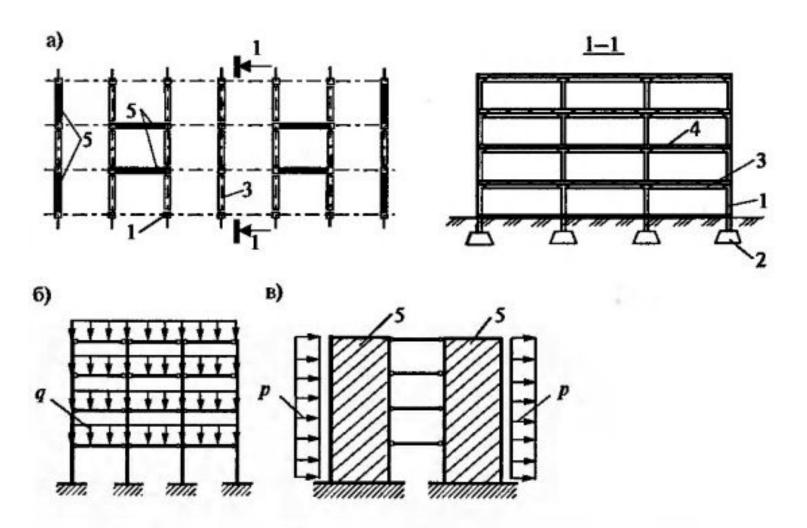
Связевой каркас здания: а) план здания, разрез; б) расчетная схема при расчете на вертикальную нагрузку; в) расчетная эхема при расчете на горизонтальную нагрузку; 1— колонна; 2— фундамент; 3— разрезной (однопролетный) ригель; 4— плиты перекрытия; 5— диафрагмы жесткости
